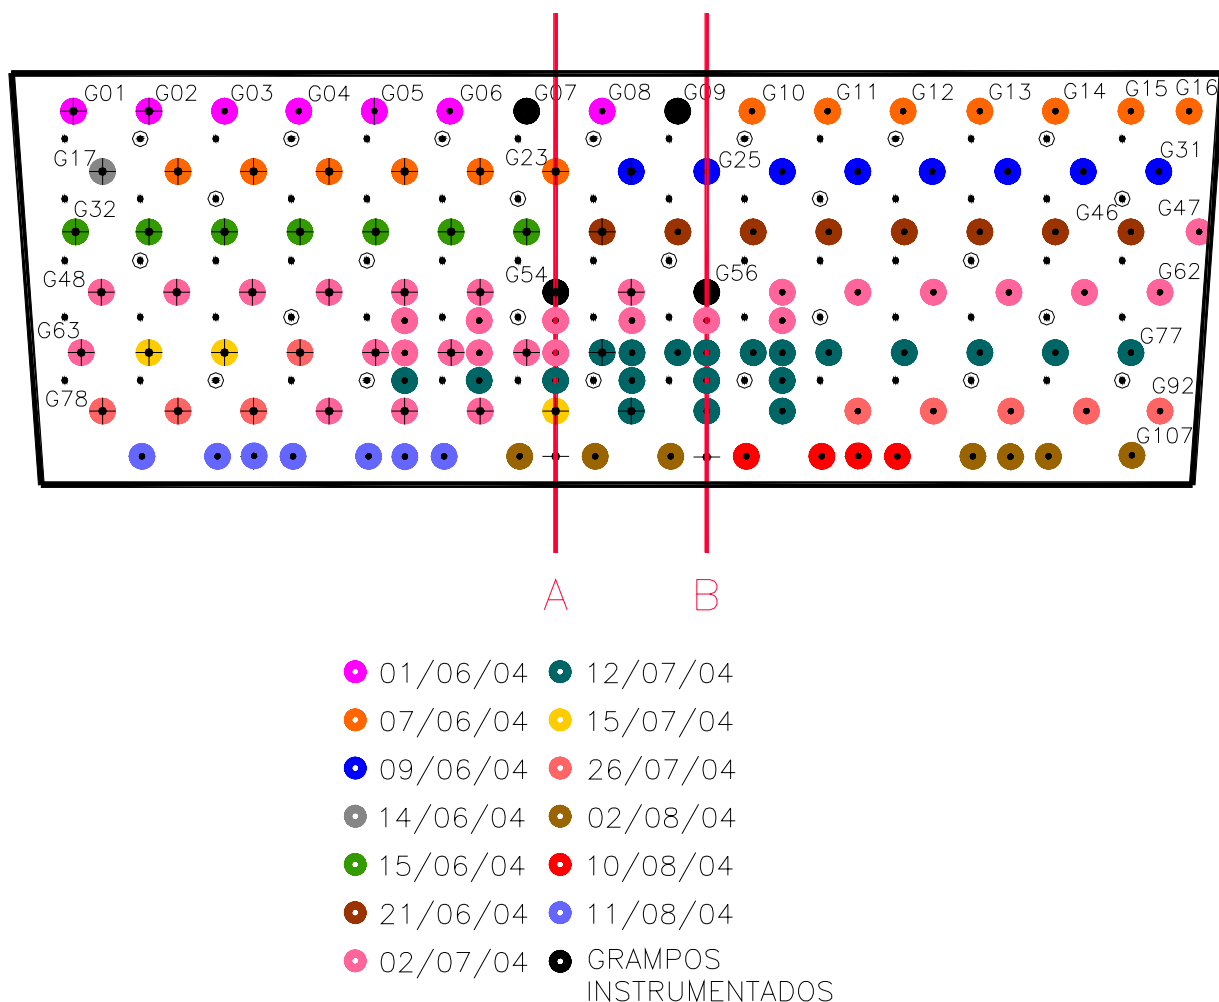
Seqüência da aplicação da “pressão de incorporação” nos grampos da Face G.
